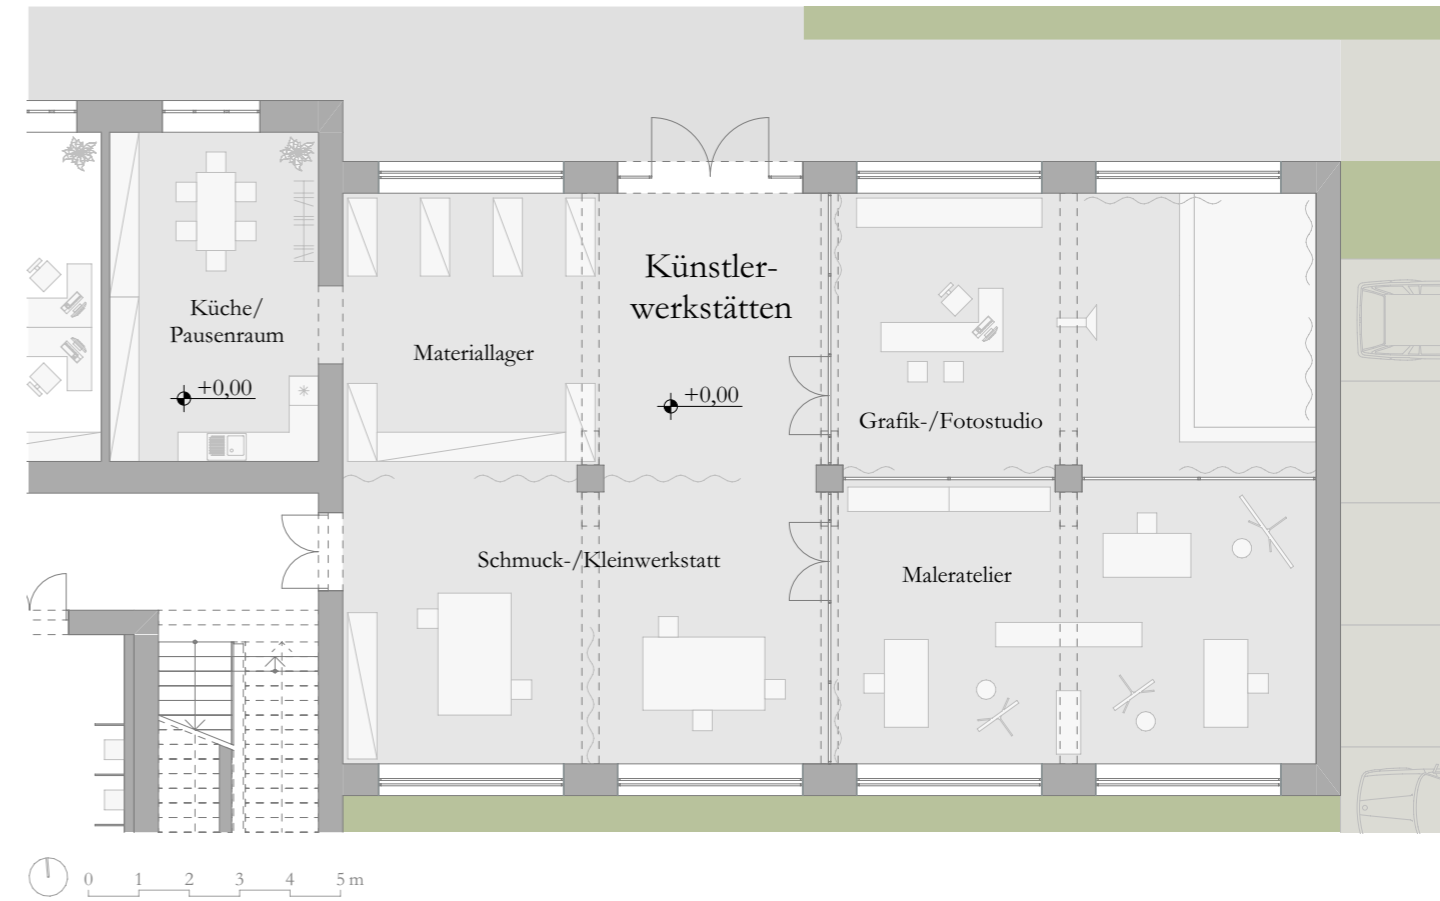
Grundriss Erdgeschoss (Detail Künstlerwerkstätten) M 1:150
